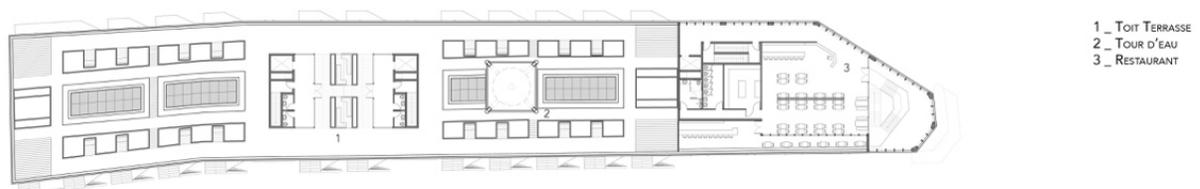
\_ Plan du 7<sup>e</sup> Étage (Toit)
